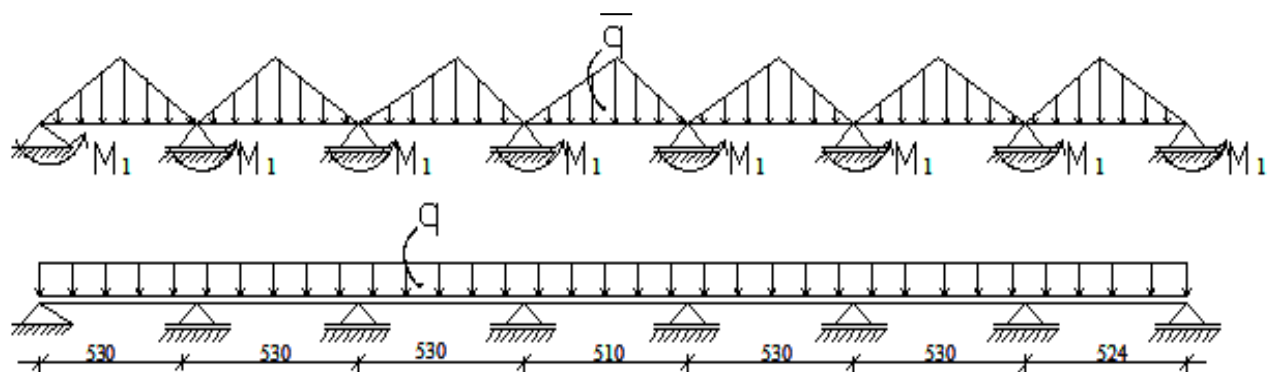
Distribution des charges sur les poutres secondaires
